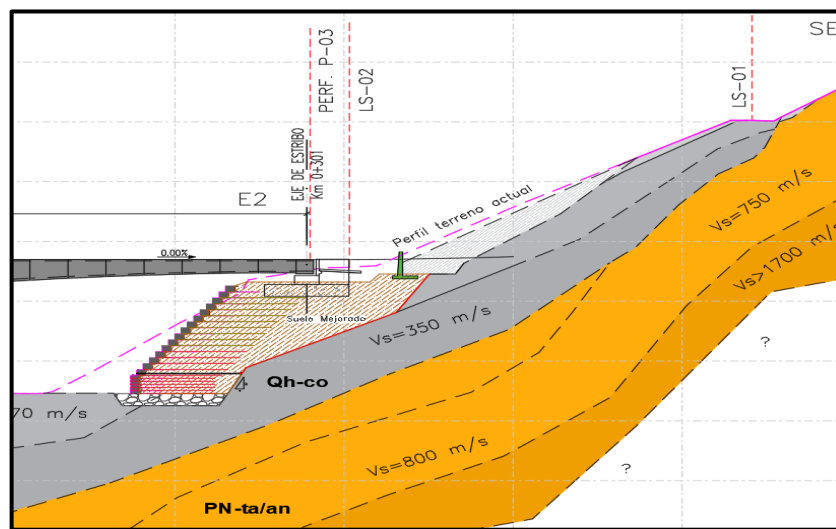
Vista del talud y el suelo reforzado en el estribo izquierdo E2.
